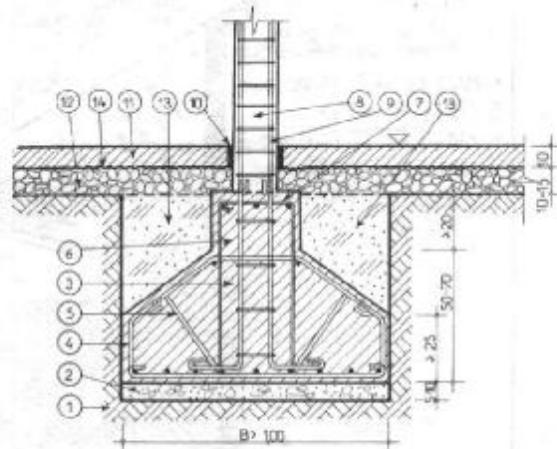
Fundație elastică de beton armat, cu talpă continuă circulară, sub formă de grindă, sub un șir de stîlpi de beton armat dispuși circular.
